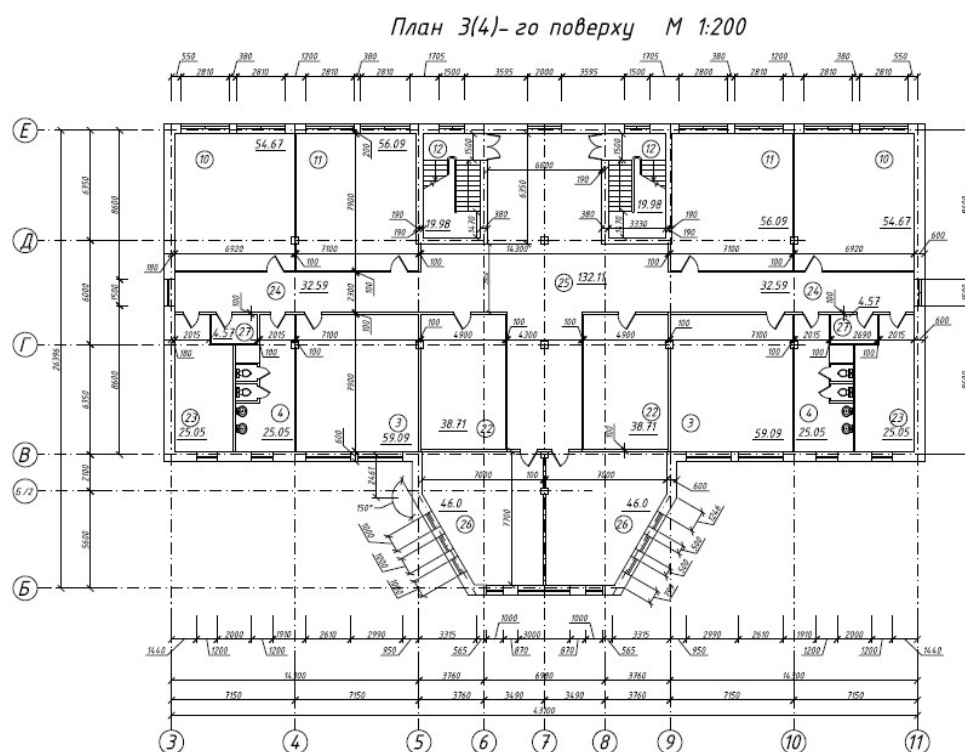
Плани 2,3 та 4го поверхів будівлі
